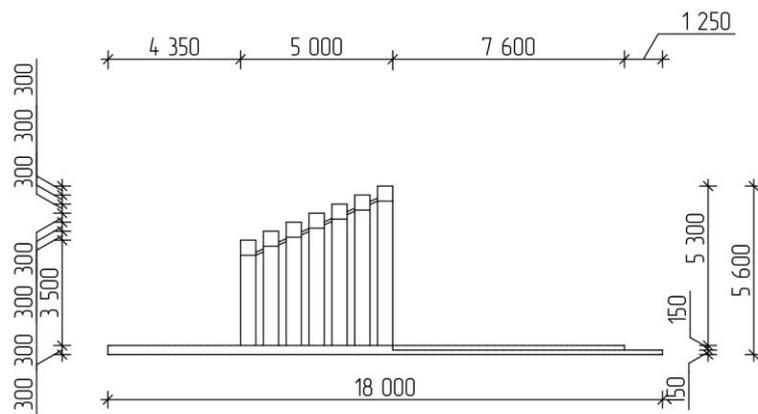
Чертеж сцены. Вид сбоку
